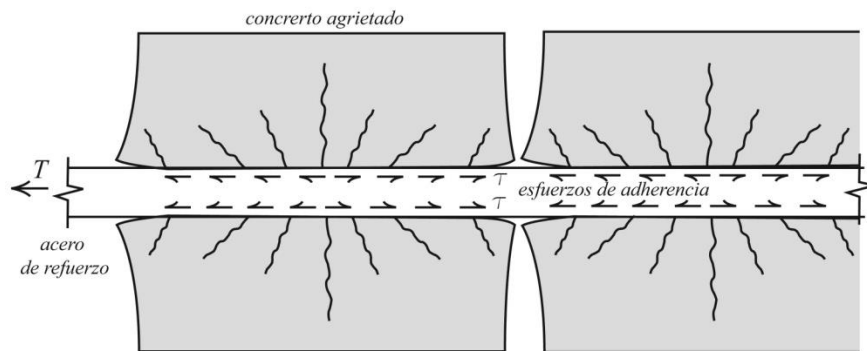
Concreto agrietado en zona de alta concentración de esfuerzos.
